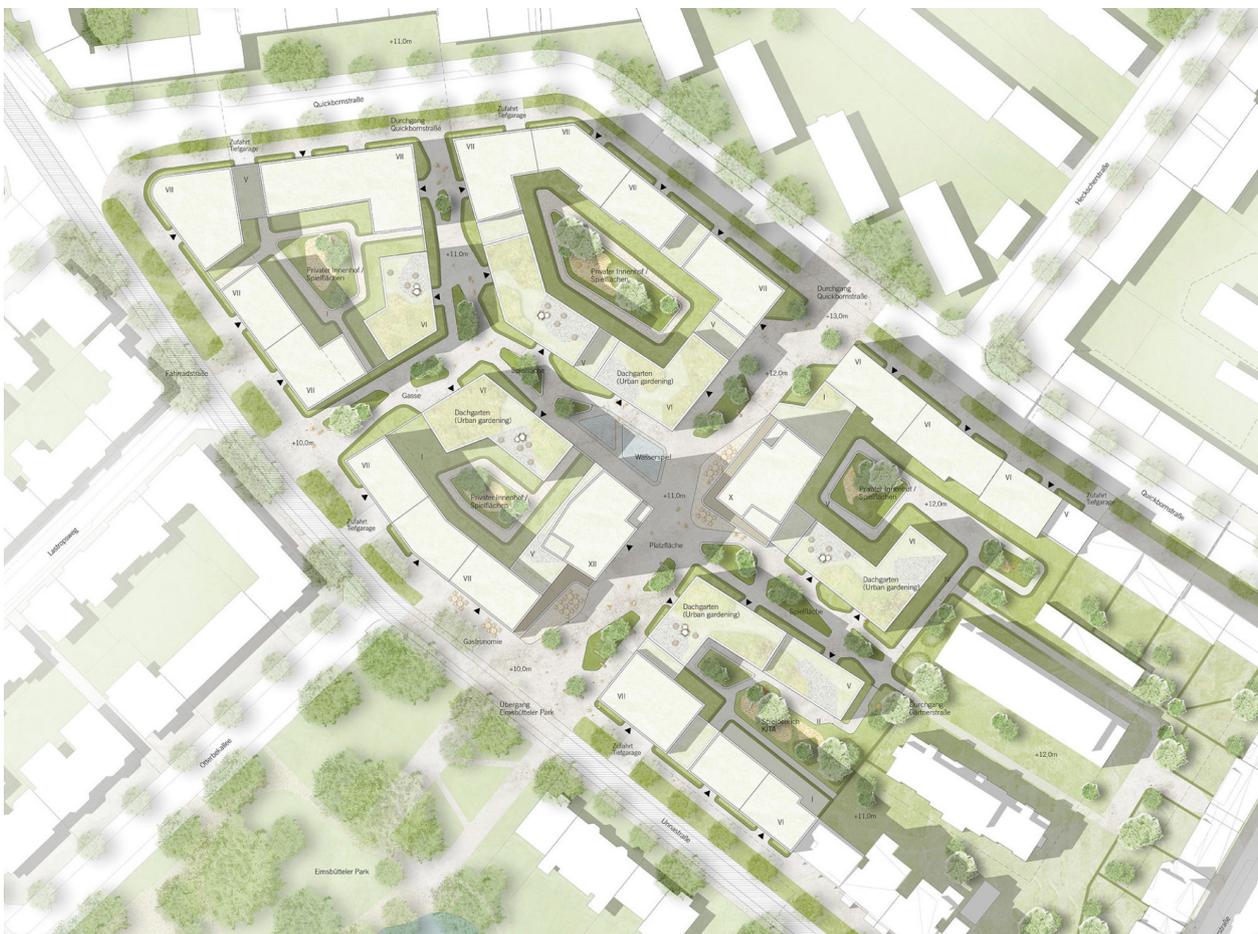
Lageplan Beiersdorf Werk 1 [7]
